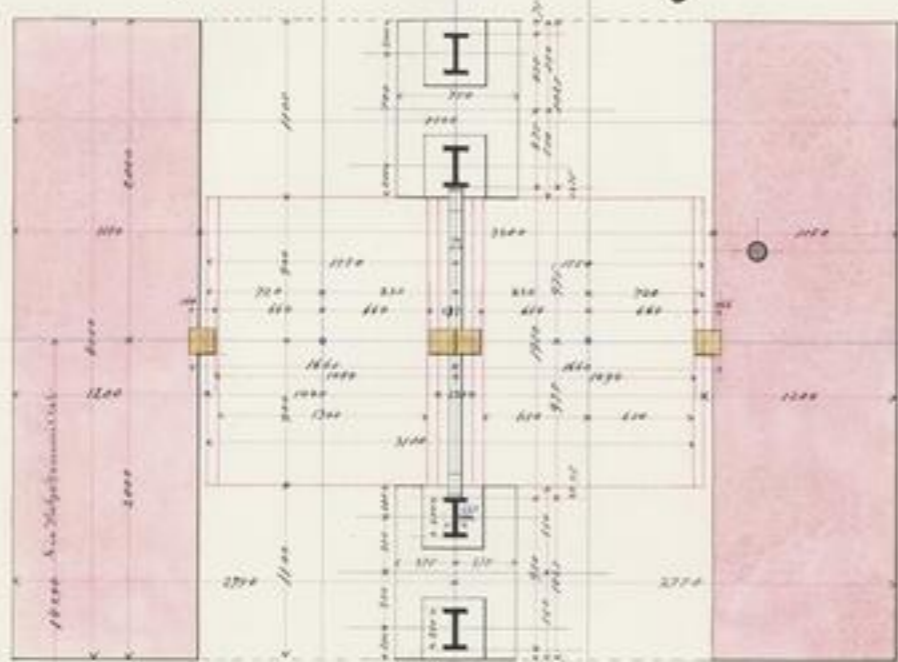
Grundriss durch das neue Streckwerk.
